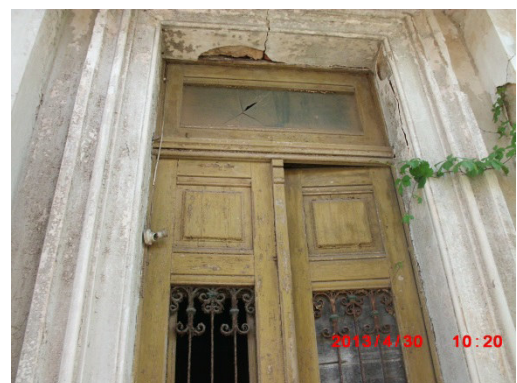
Porta principal do Piso 1: fissura F5
